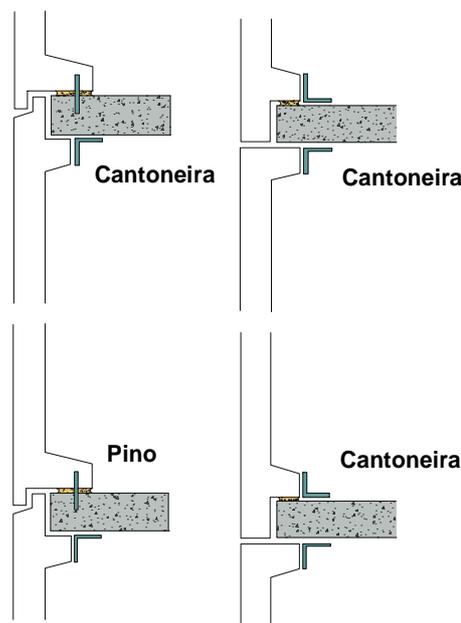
Fixação de painéis de concreto (BROOKES, 1998).
